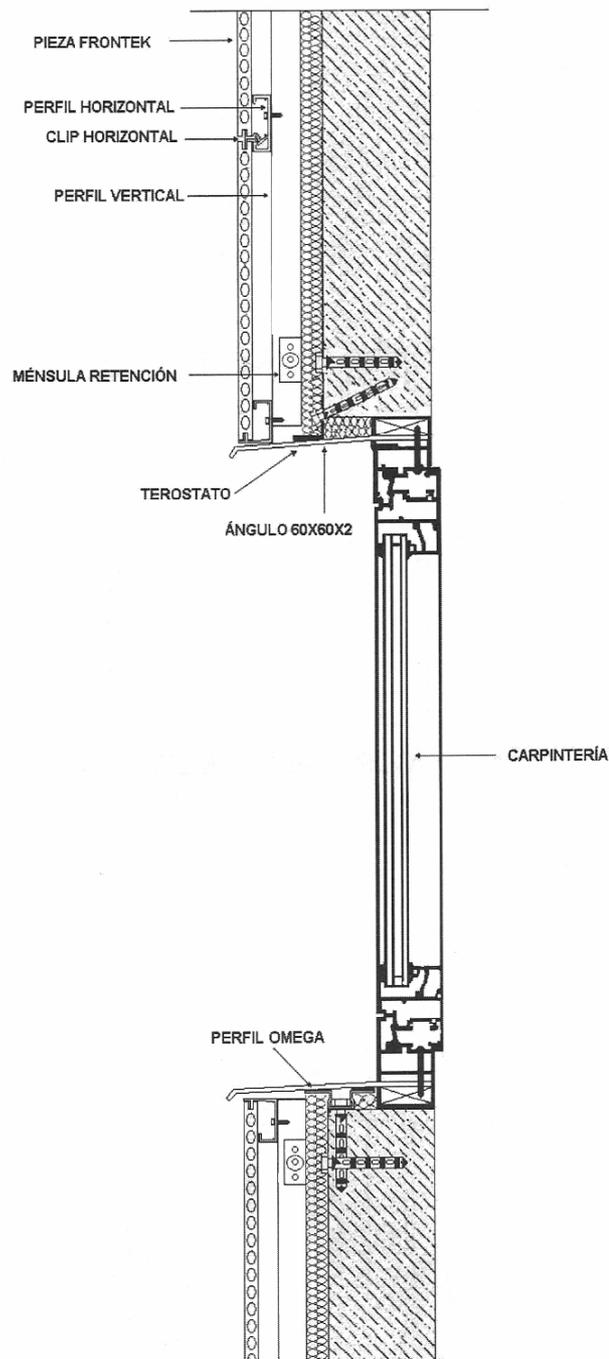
SECCIÓN VERTICAL POR RECERCADO METÁLICO.
